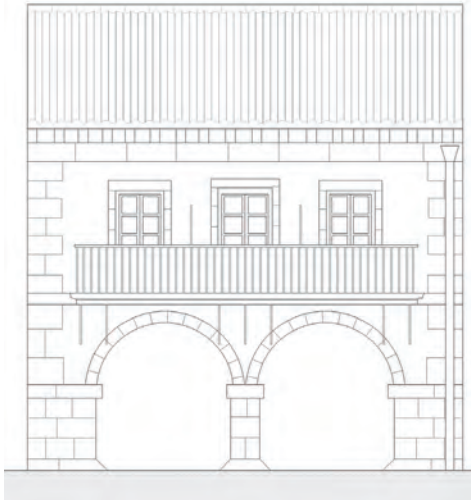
3. ALZADO A ATZIETA KALEA
